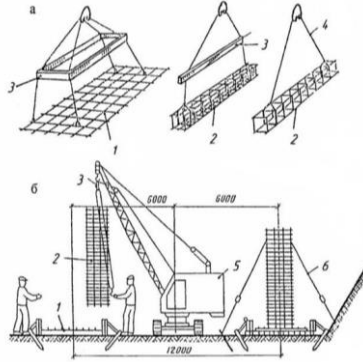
Установка арматурных изделий краном (Примечание: а – подача; б – установка; 1 – сетка; 2 – каркас; 3 – траверсы; 4 – строп; 5 – кран; 6 – расчалка)
